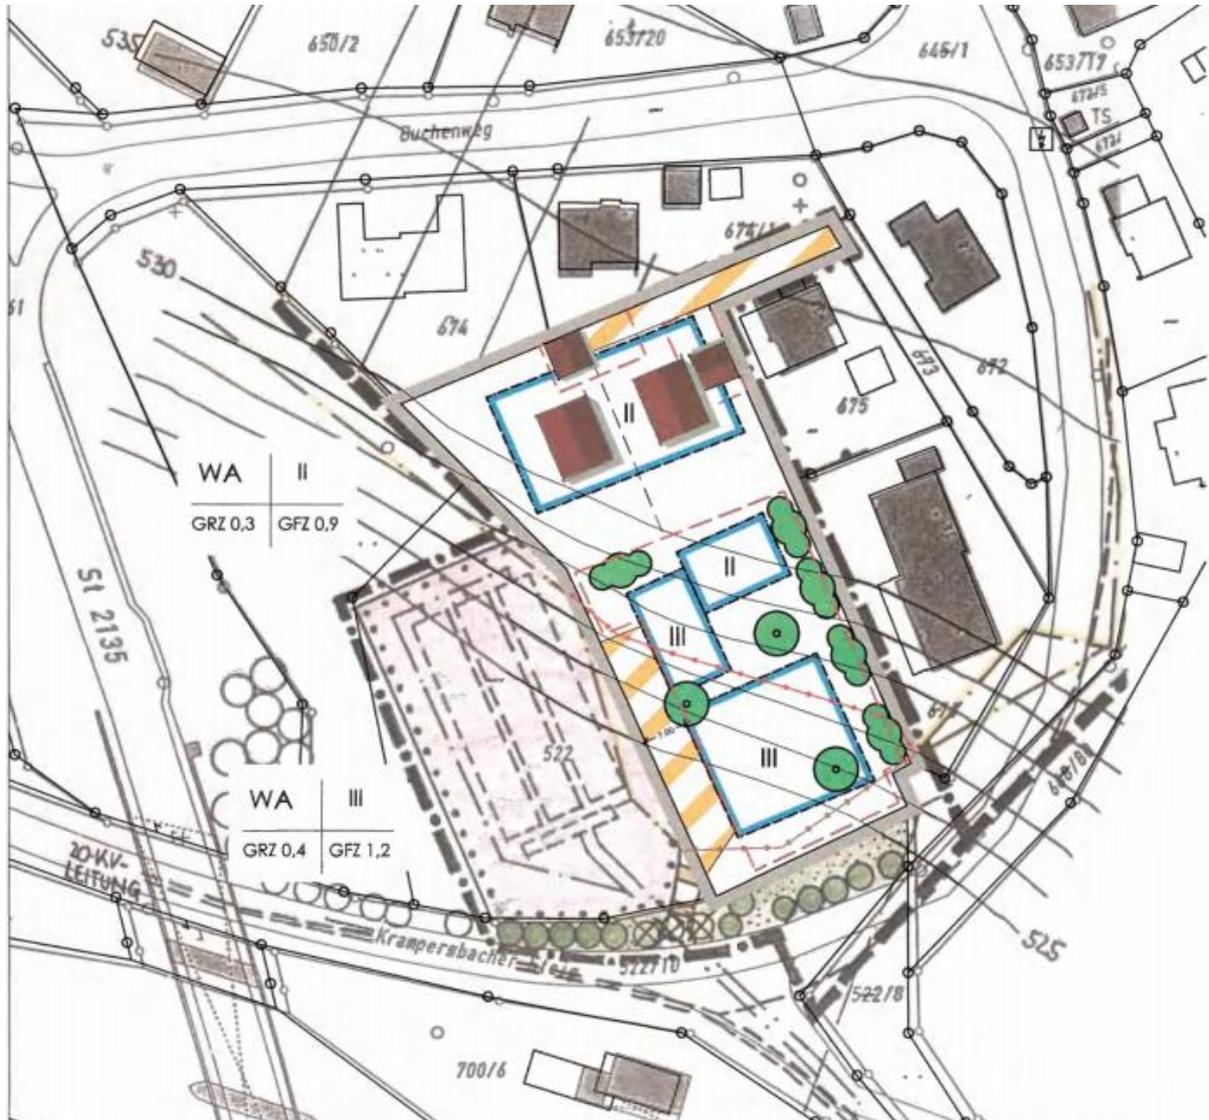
Auszug aus dem Deckblatt Nr. 16 des Bebauungsplans „Bürgerholz – Süd“ –maßstabslos
